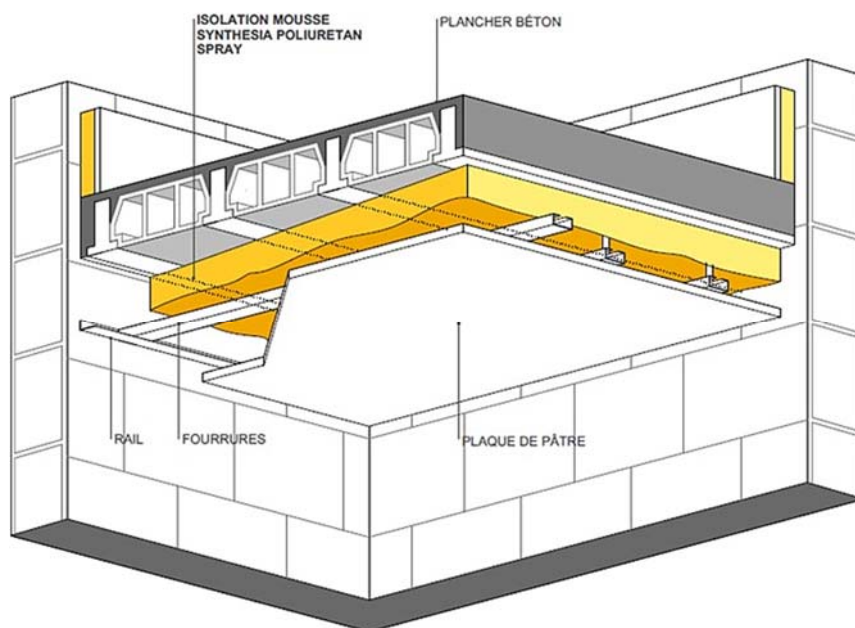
Isolation du plafond sous un plancher béton constitué de montants simples ou doubles sans dispositifs de suspension au support
